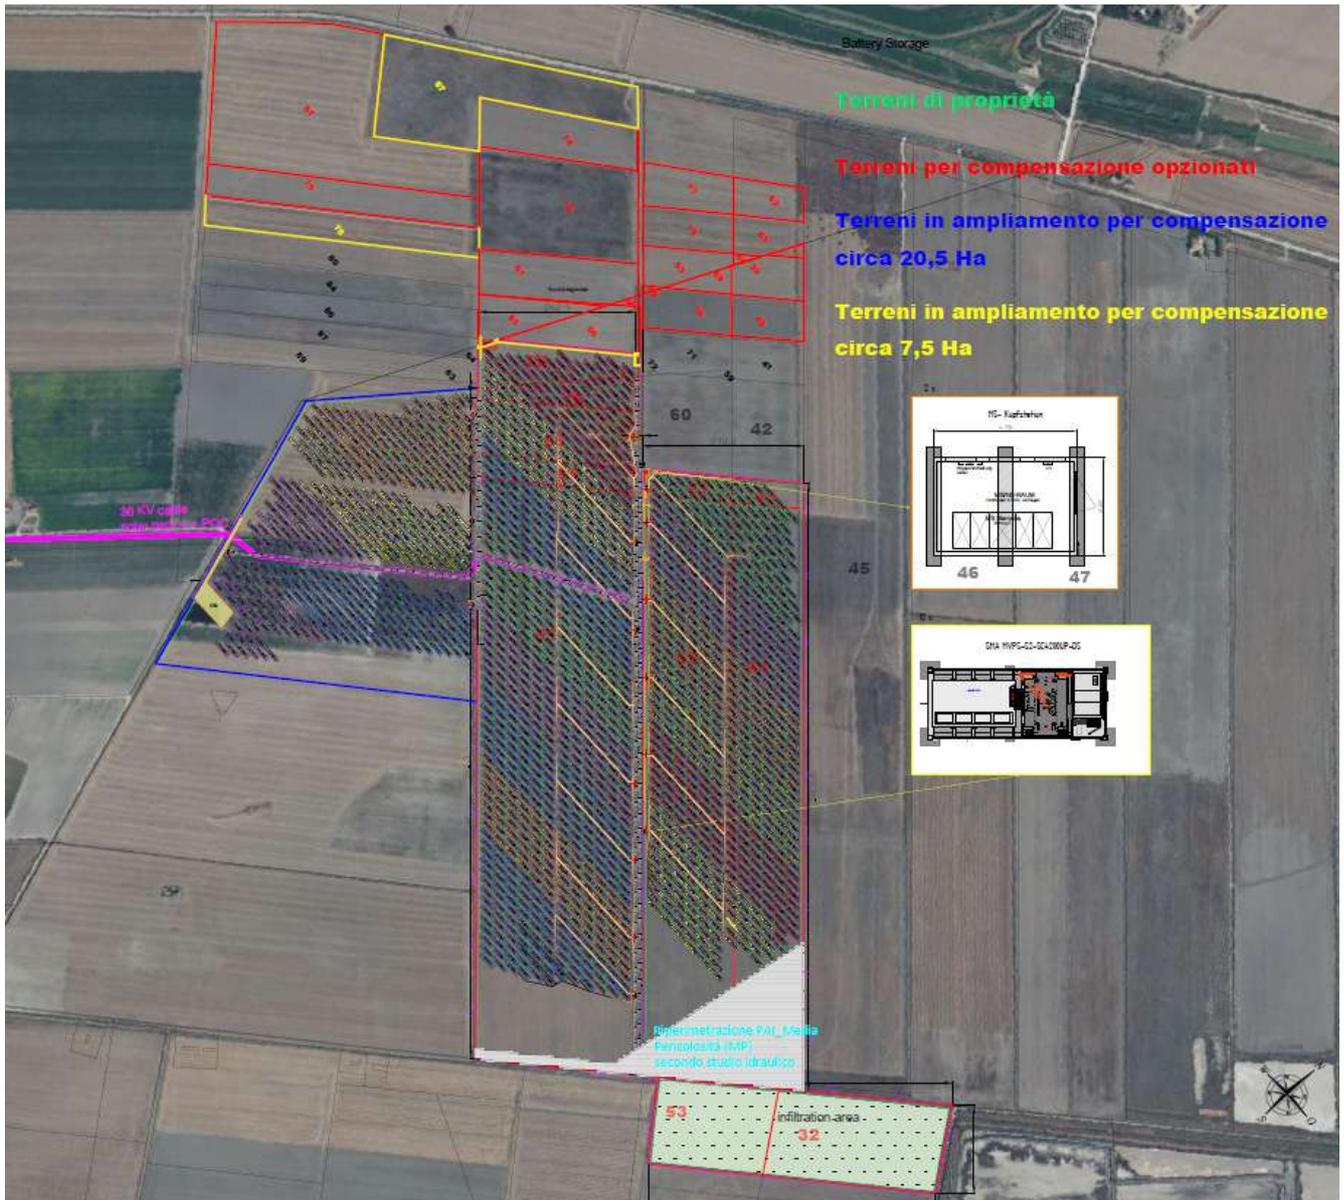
Ortofoto con dettaglio dell'impianto fotovoltaico
